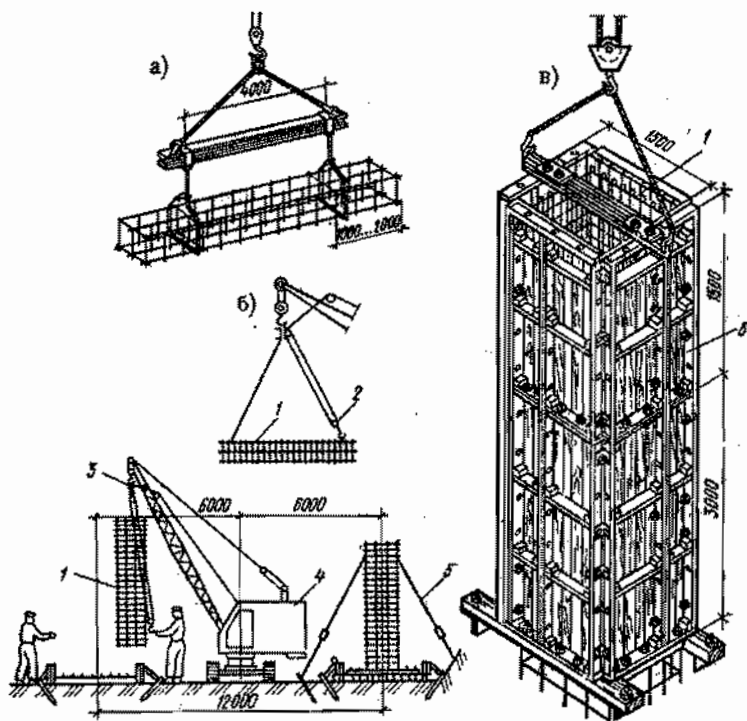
Монтаж арматурных каркасов и арматурно-опалубочных блоков: 1 - каркас; 2 - блок вспомогательного крюка; 3 - полуавтоматический строп; 4 - кран; 5 - расчалка; 6 - щитовая опалубка
